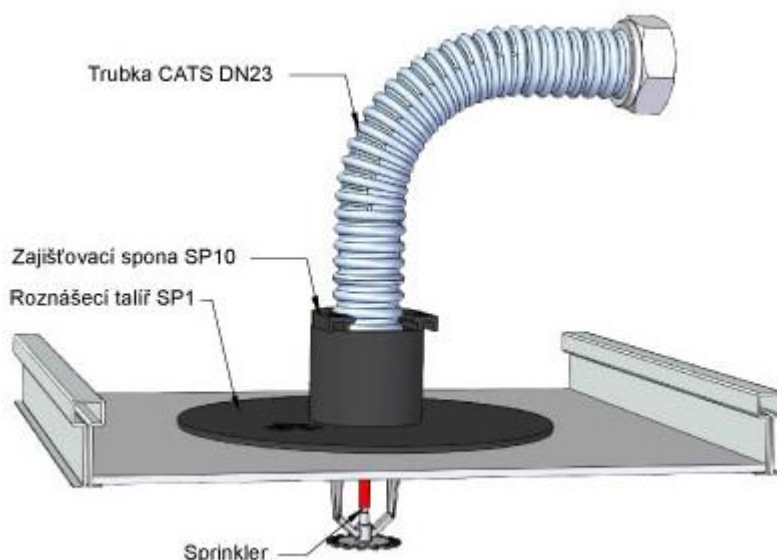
Zakončení trubky na straně připojení 1/2" sprinkleru
